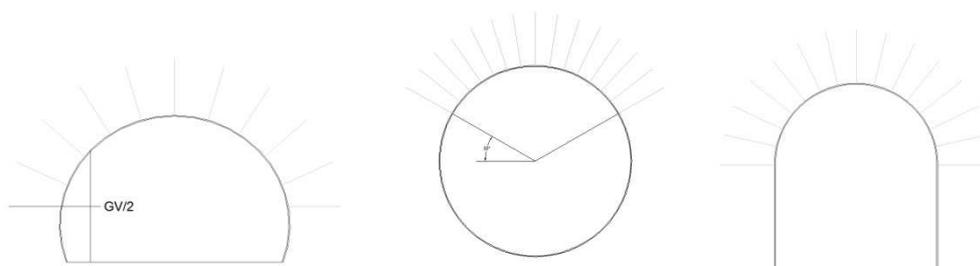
Localización de zona de refuerzo superior en las tres tipologías de túneles
